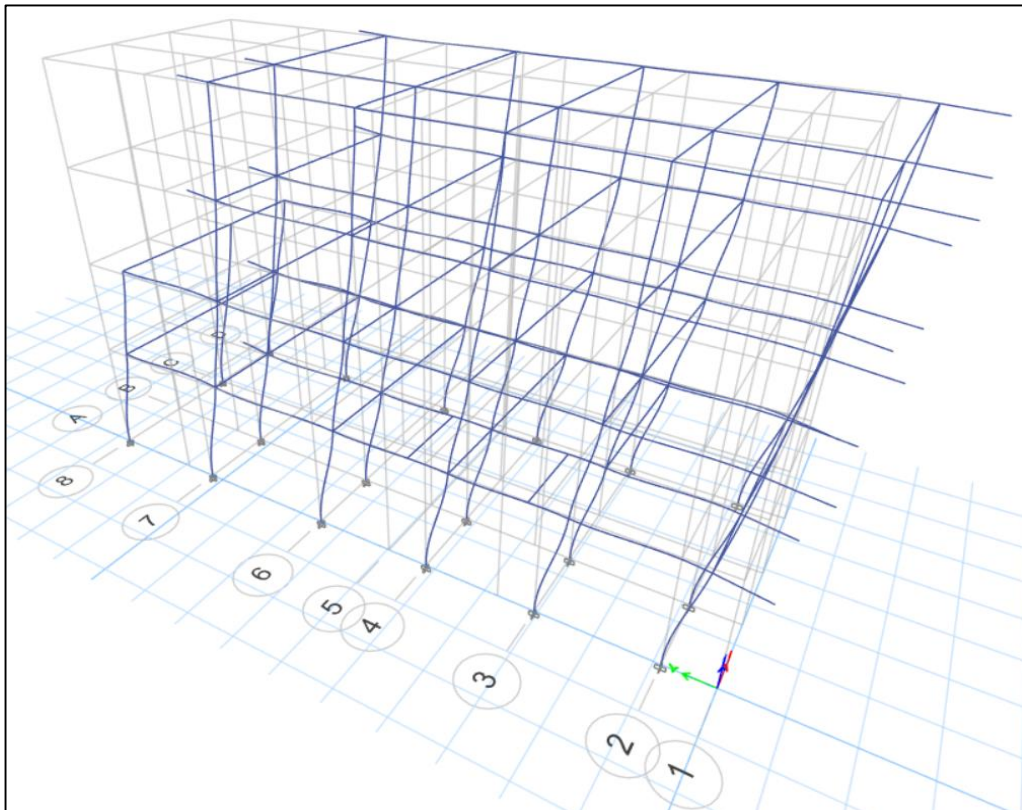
Primer modo de vibración con vigas de sección variable de 12.65°.
